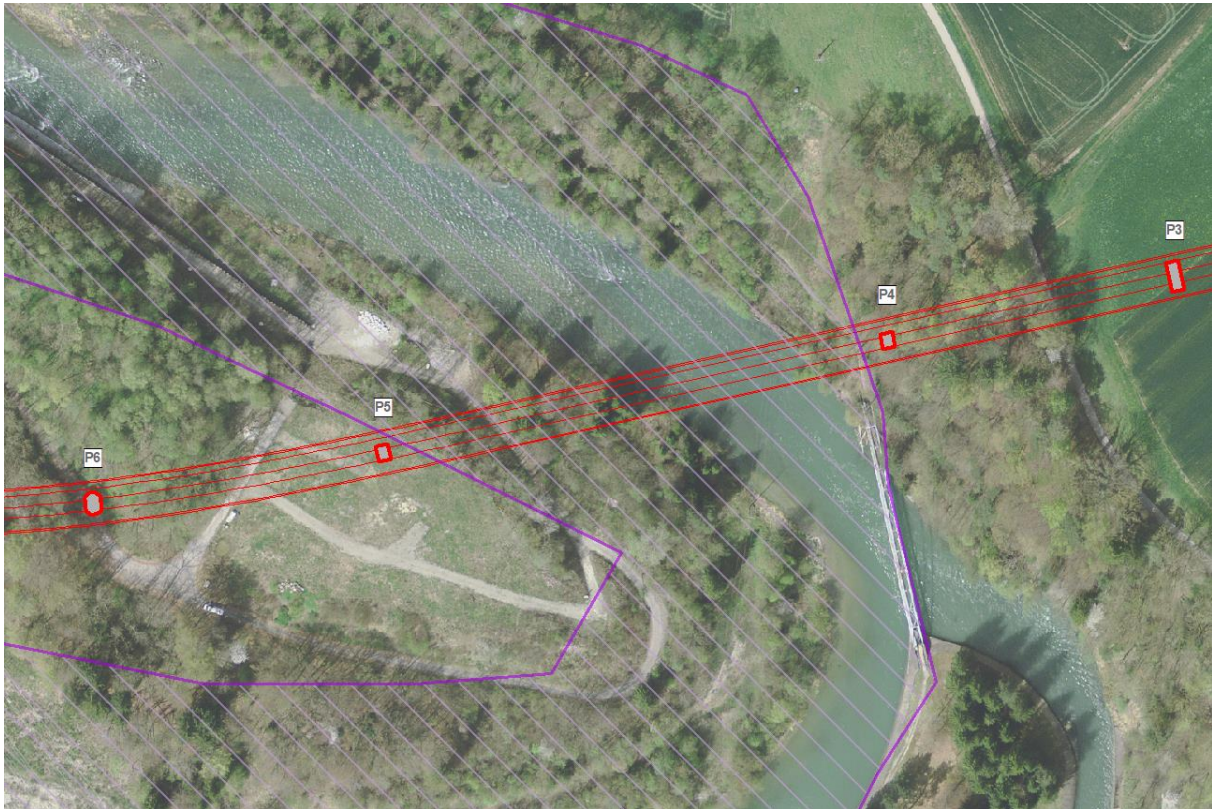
Zone alluviale et piles du pont d'Hauterive
